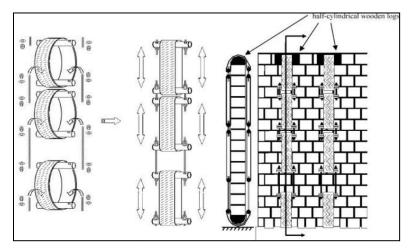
Detalles de la construcción del postensionado con bandas de neumático. Fuente: A Critical Review of Retrofitting Methods for Unreinforced Masonry Structures. Andrew Smith & Thomas Redman. January 2009
